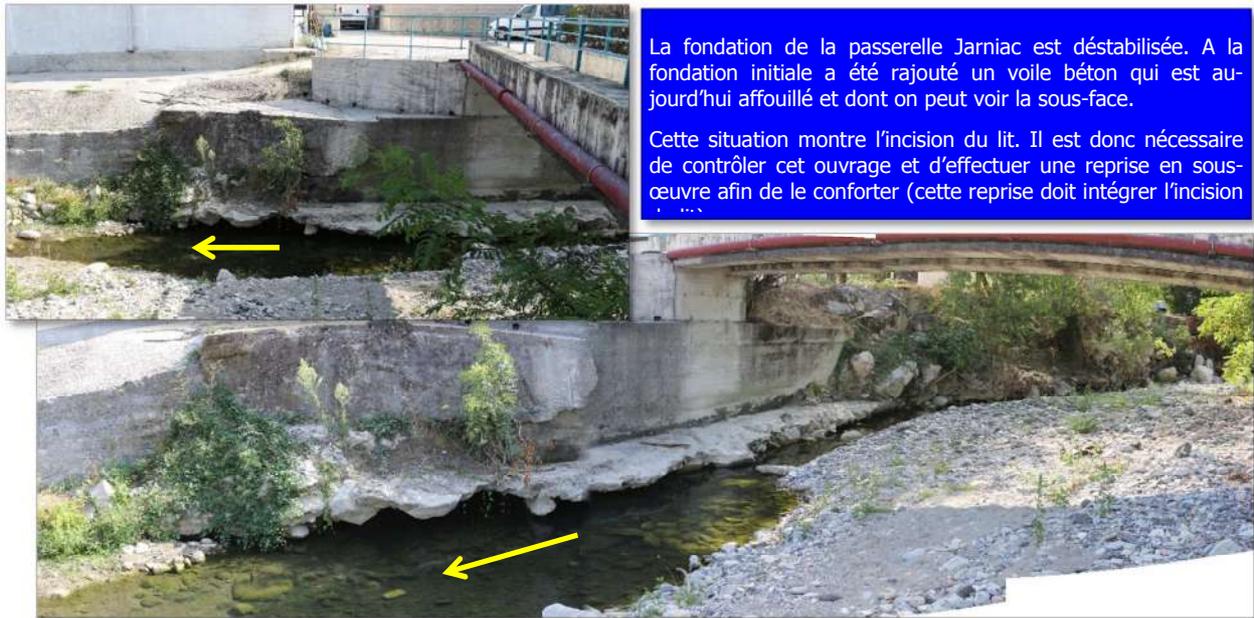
affouillement de la fondation de la passerelle Jarniac
